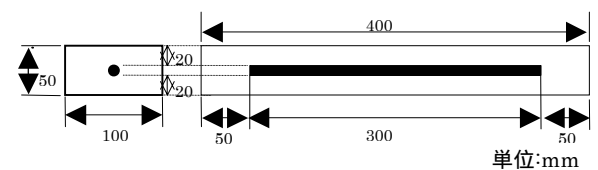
コンクリート・モルタル供試体図(鉄筋入り)
